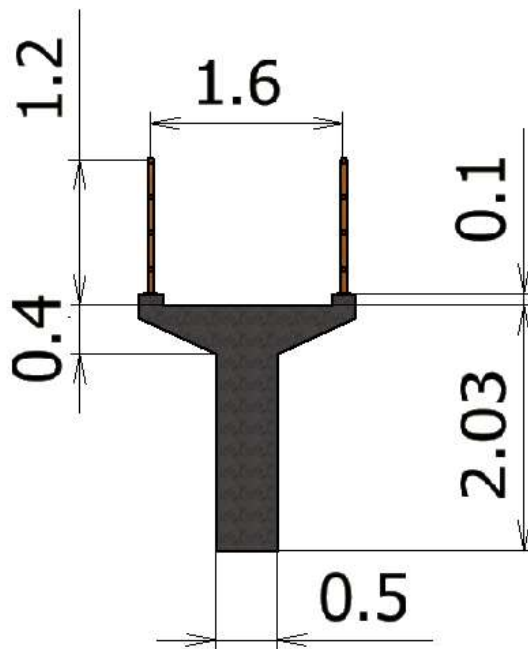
Sección longitudinal del puente en concreto reforzado
